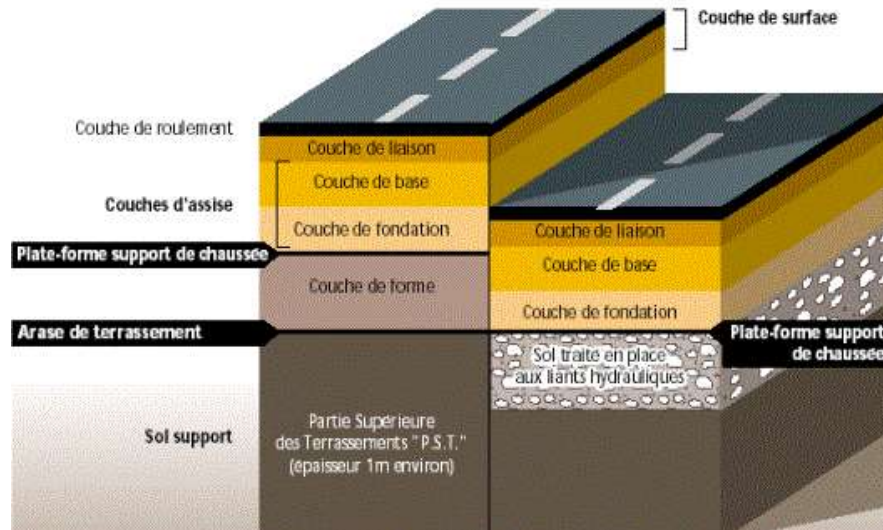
Les différentes couches qui constituent la structure de la chaussée.
